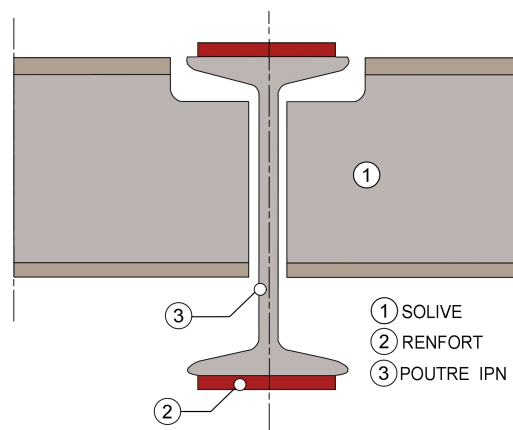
Ajout de plats soudés sur les semelles.
